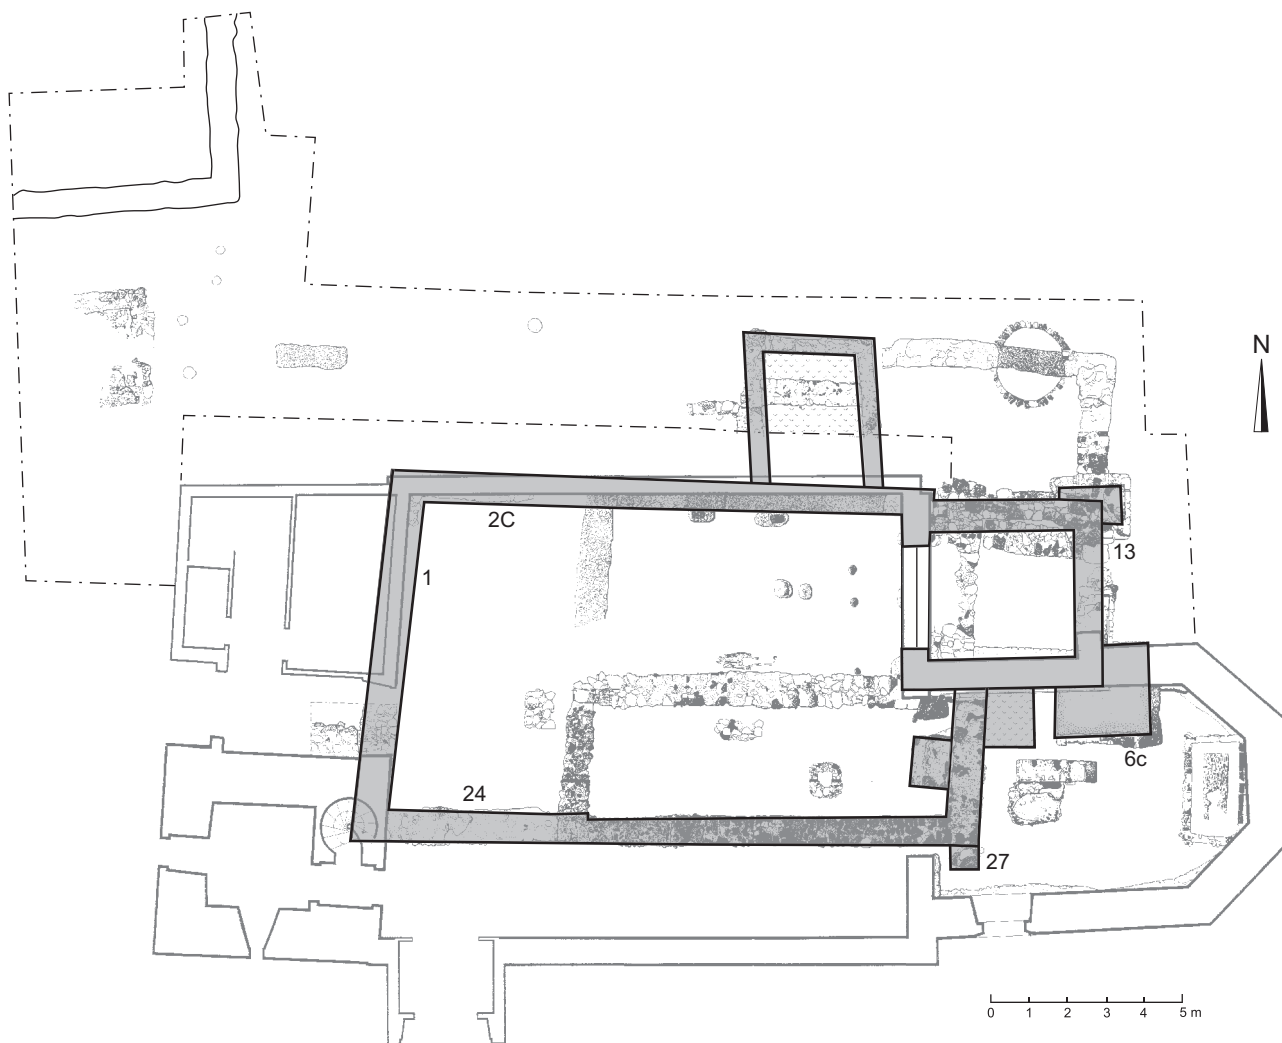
Winterthur-Veltheim. Grundriss der westlich verlängerten Kirche mit Chorturm. M. 1:200.
